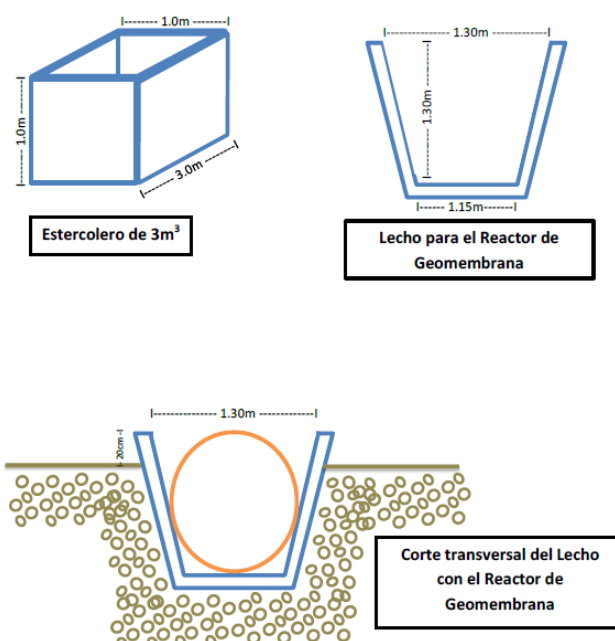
Plano de construcción de instalaciones para el sistema de biodigestión, vista transversal.
